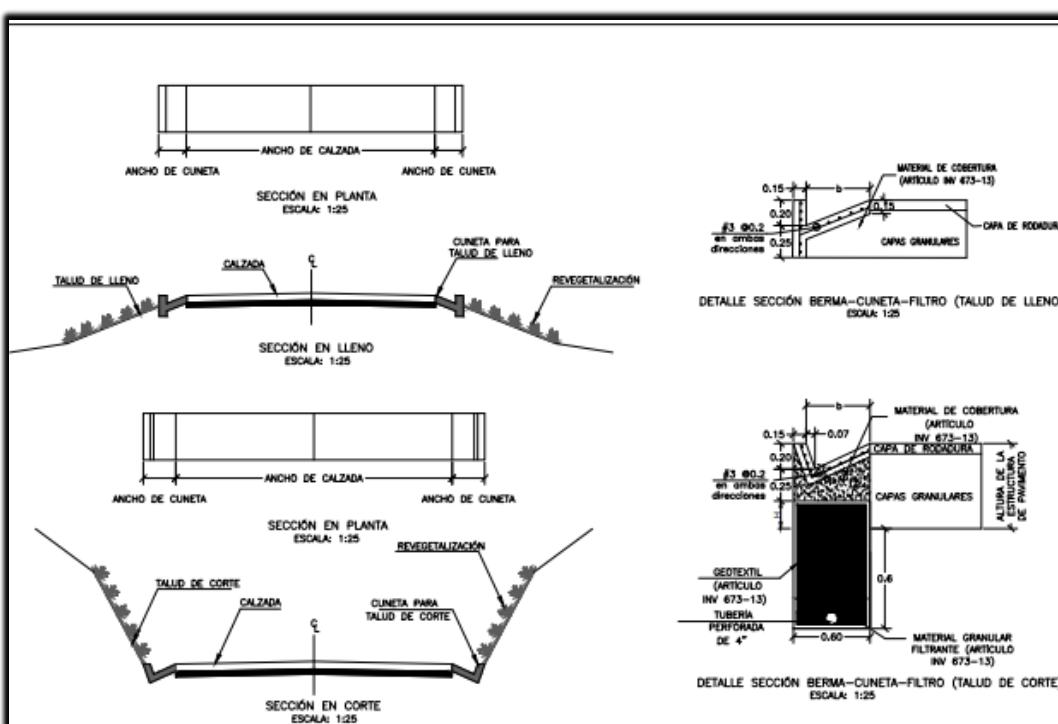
Detalle sección en planta y corte transversal de calzada y obras de drenaje.
